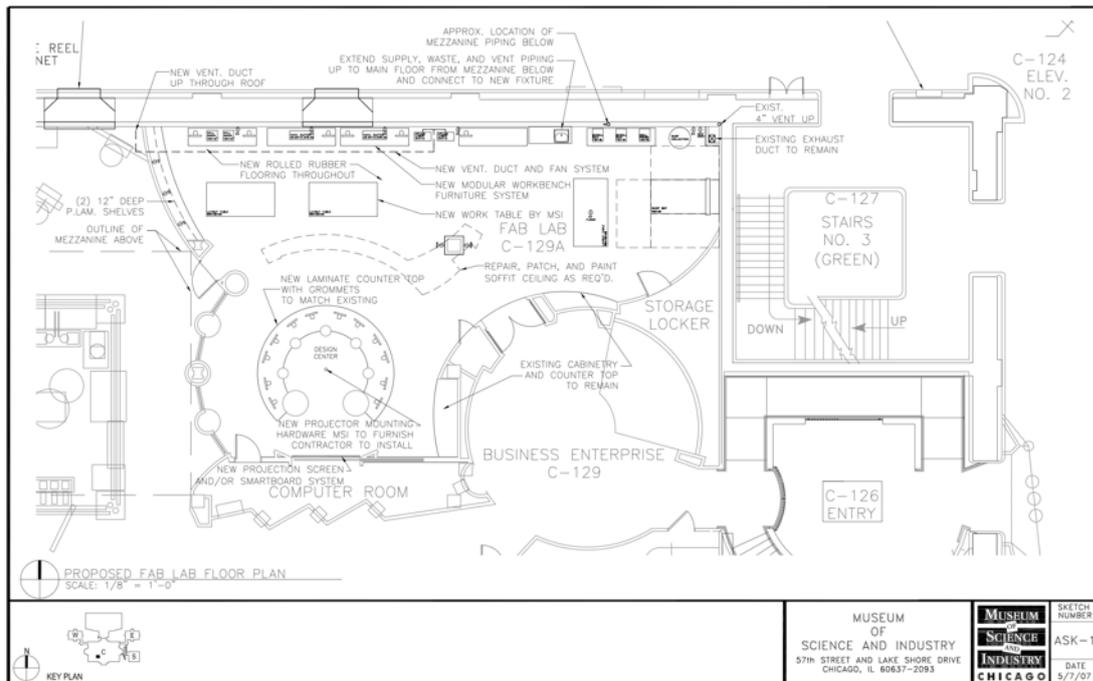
Plano del Fab Lab Chicago (Fuente: Fab Foundation)
